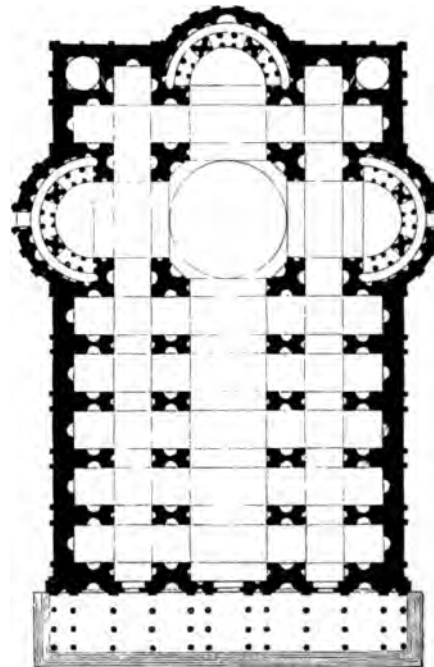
St. Peter. Rafaels Grundriss.
